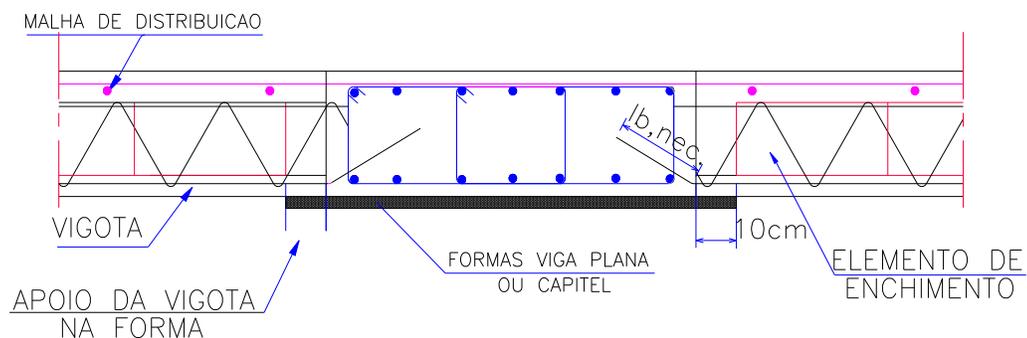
Detalhe de apoio das vigotas em viga plana ou capitel.
